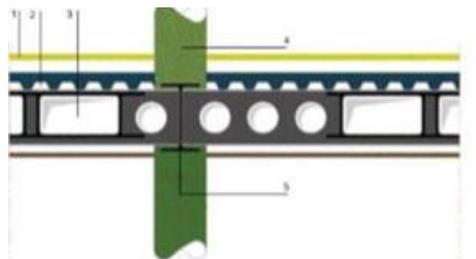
les jonctions entre les poutres alvéolaires et les poteaux mixtes
